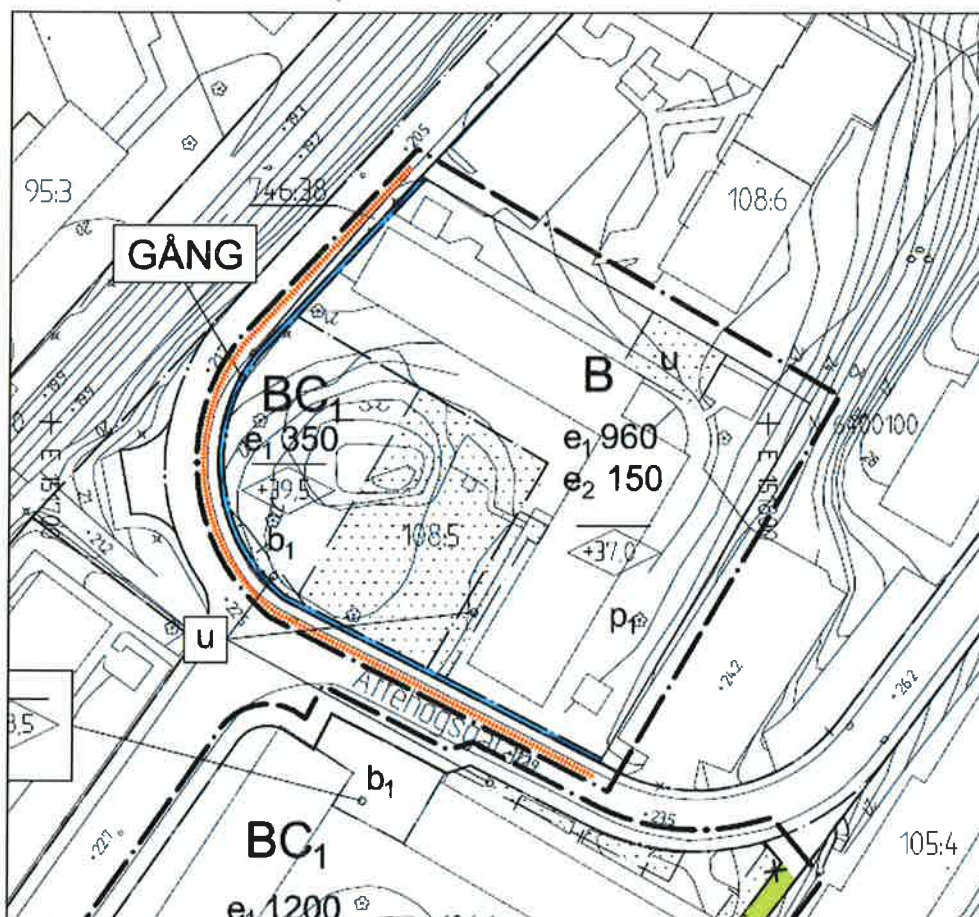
Inzoomning i plankartan för fastigheten Källtorp 108:5, gatumarken breddas med 0,75 m inkl stödremsa (illustrerat med blått). Plangränsen är illustrerad 3 m utanför verkligt läge.
